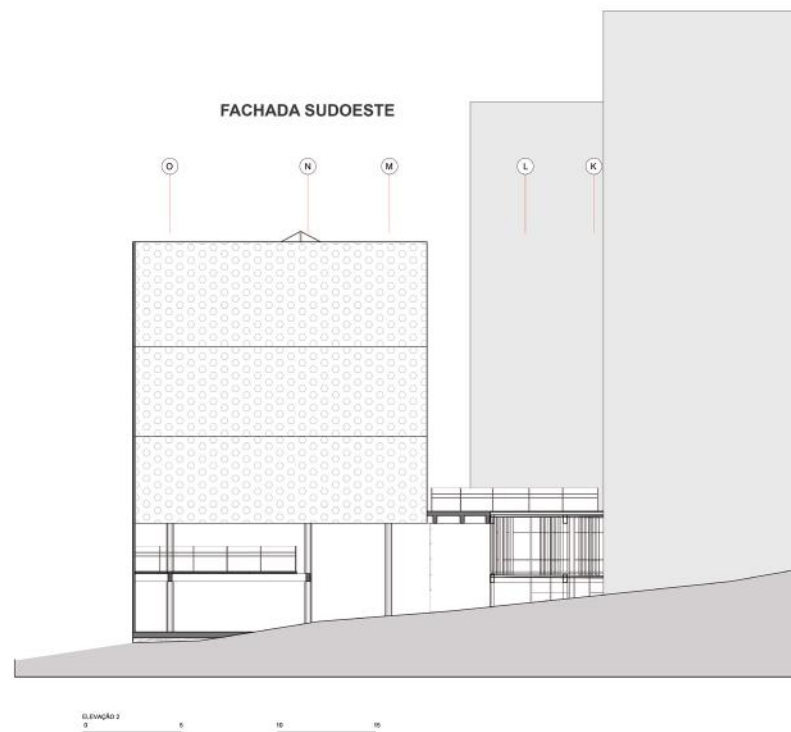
Elevação 2 - Entrada Rua Venceslau Brás | Projeto de Laís Paraizo, 2019.
